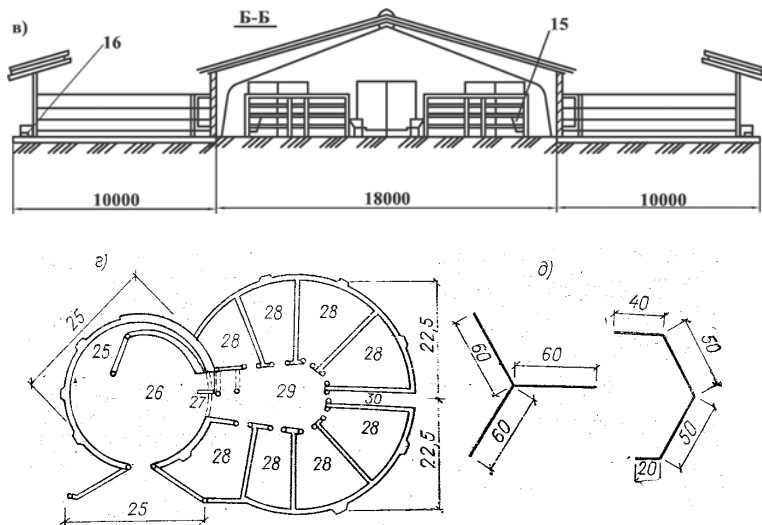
Схеми будівель і споруд для табунного утримання коней:
